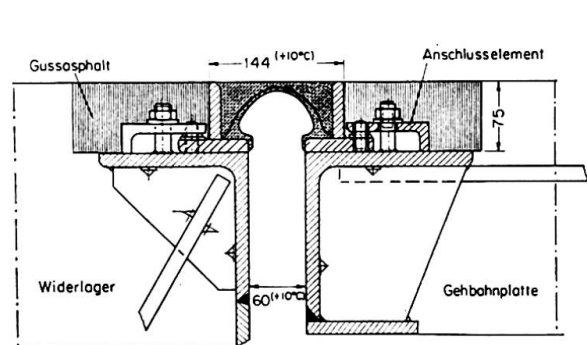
Anschluß des Gehbahnüberganges an die Unterkonstruktion.
